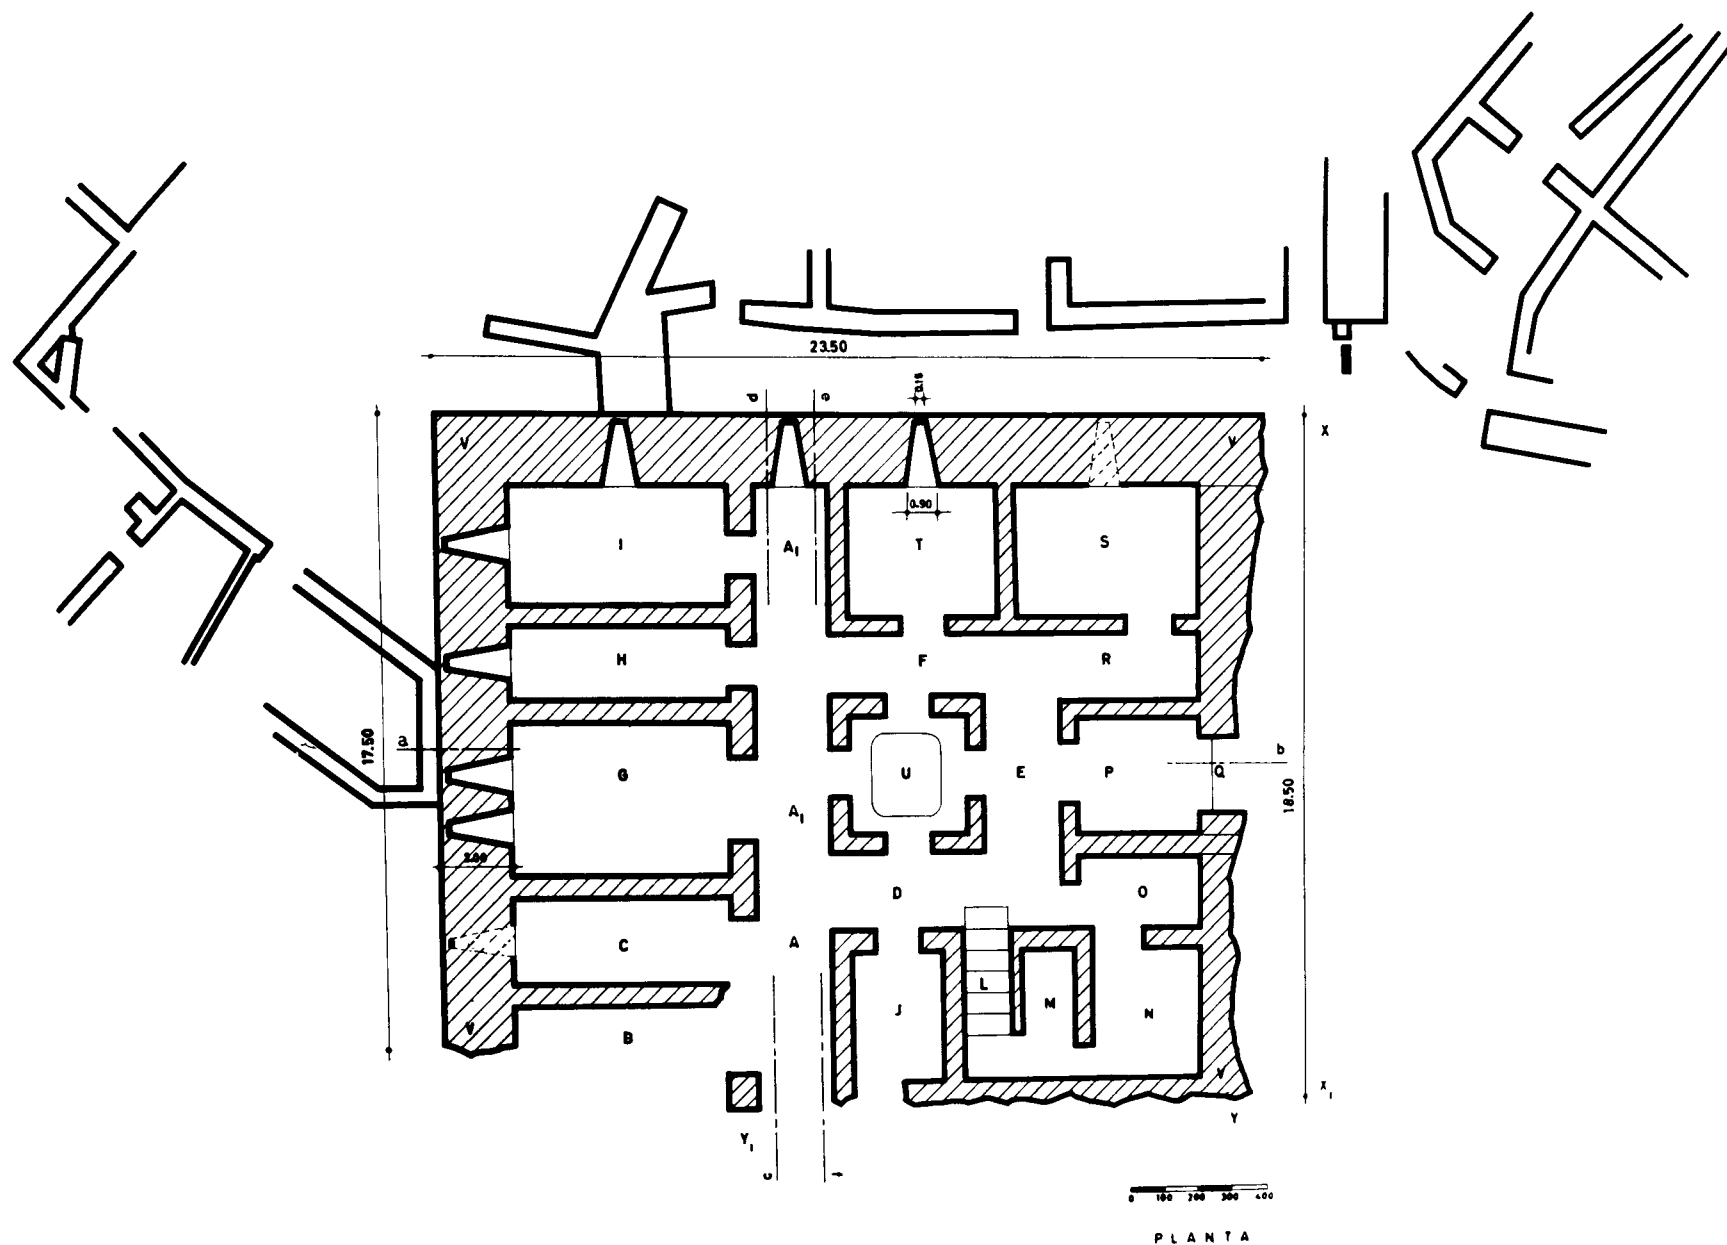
Planta do Castelo da Lousa, com indicação das construções exteriores anexas a Norte e a Sul, bem como do corredor e respectivo muro que se estende ao longo da muralha Oeste da fortificação.
